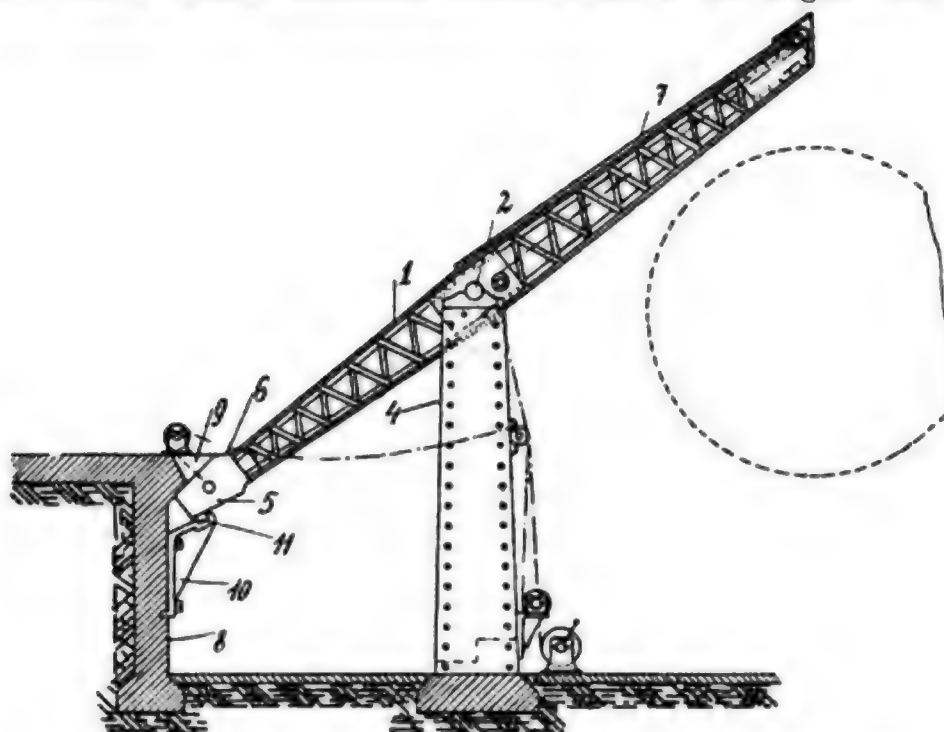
Luftschiffhalle mit aufklappbarem Dach.
